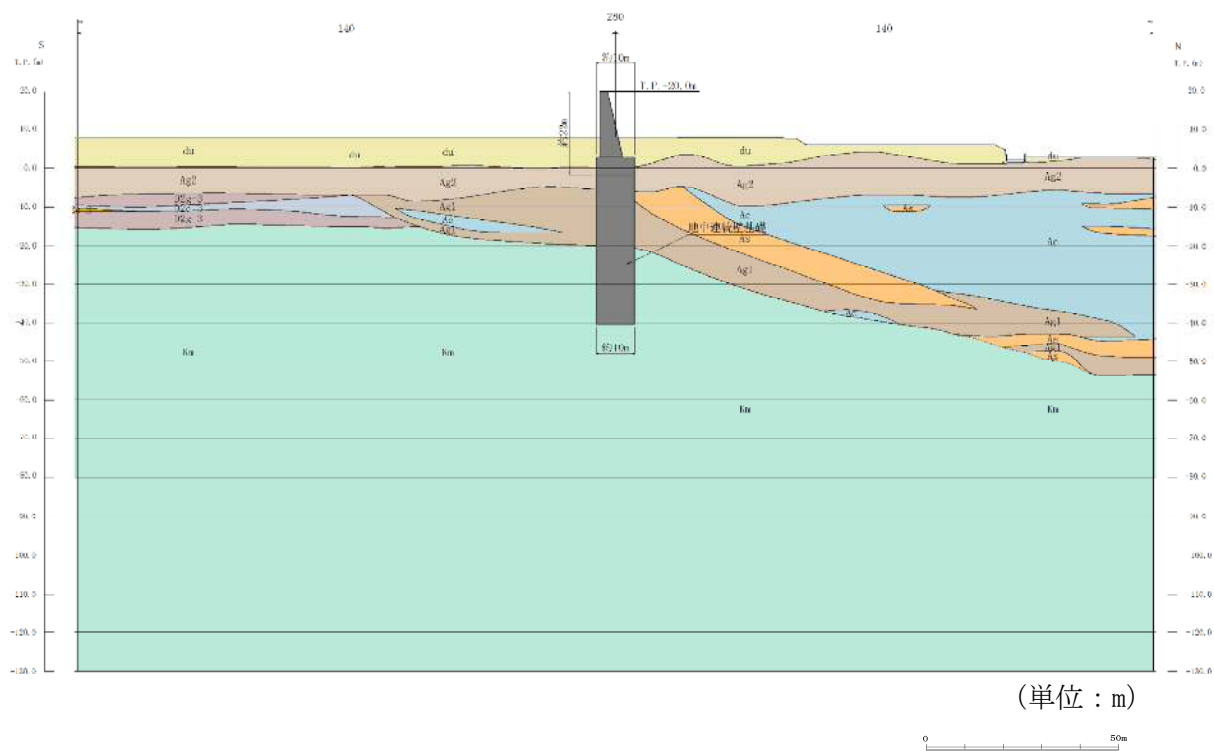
10. 3-3(1) 鉄筋コンクリート防潮壁 断面図(A-A断面)
